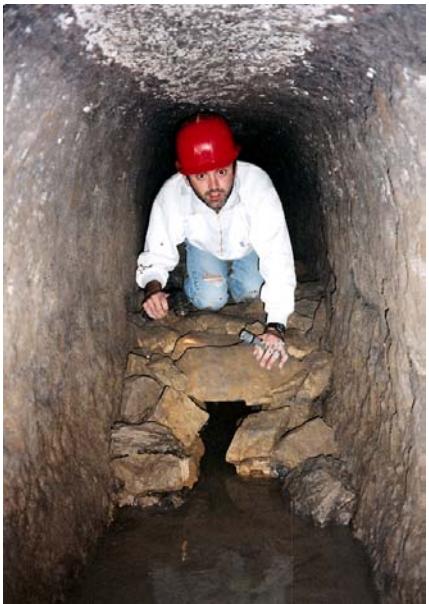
Début de la conduite d'eau construite entre les puits 8 et 9
